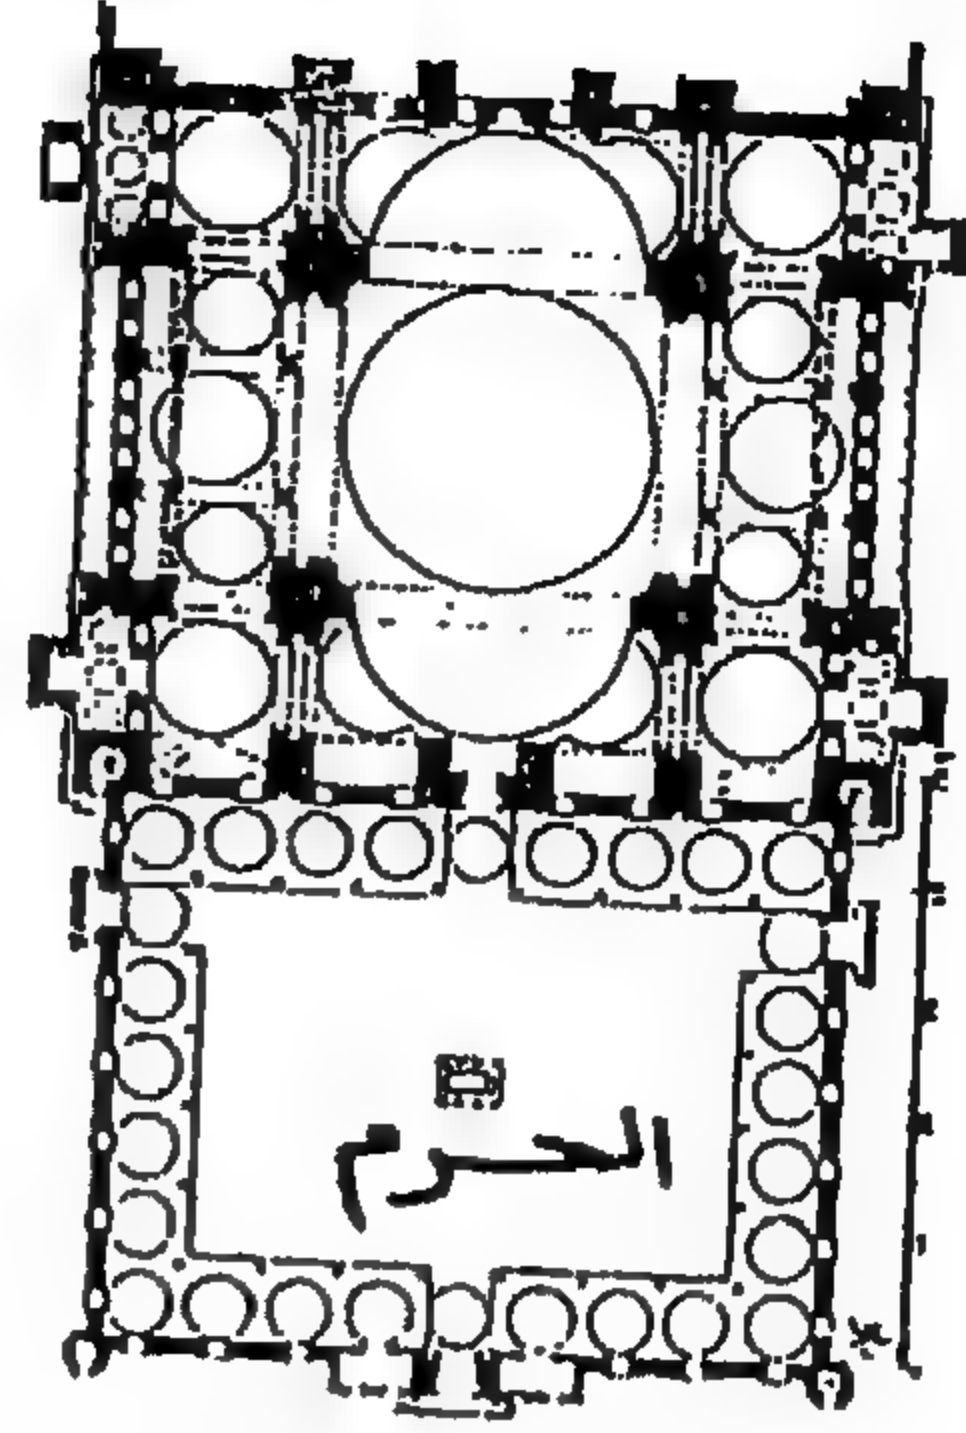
مسقط أفقي لجامع أوج شرقلي في أدرنة (عن : Goodwin)
